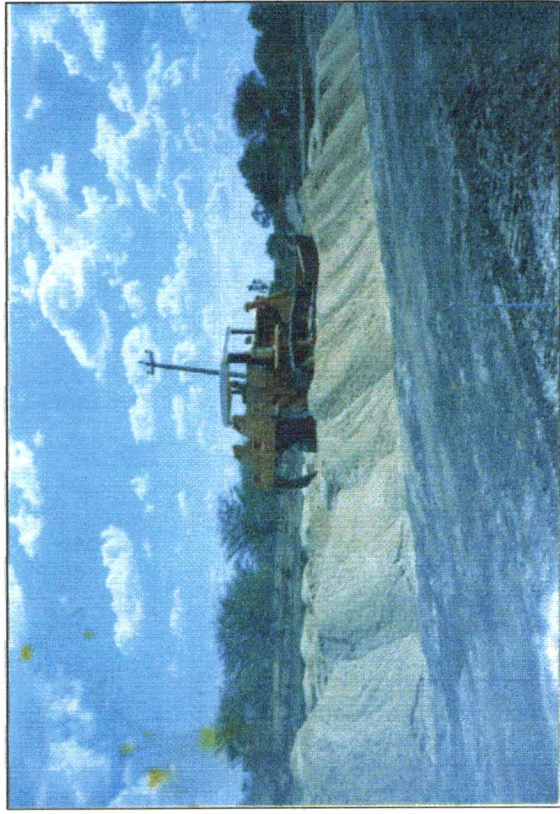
Espalhamento de areia para dreno horizontal.
